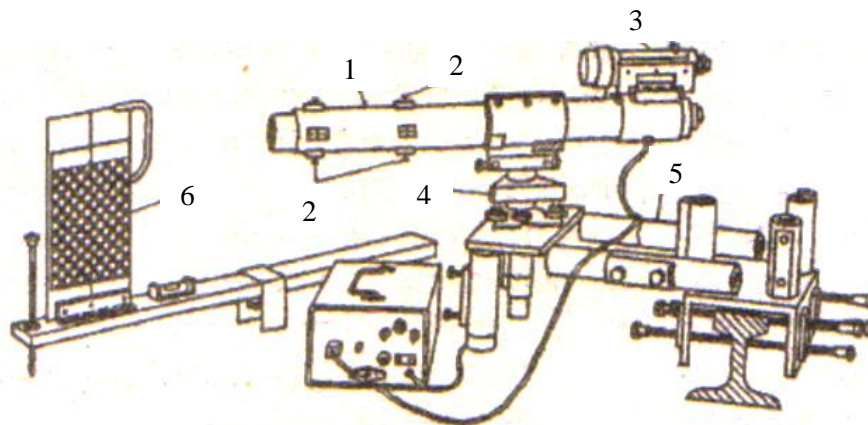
Прибор на базе нивелира НЗ и лазерной приставки ПЛ-1
